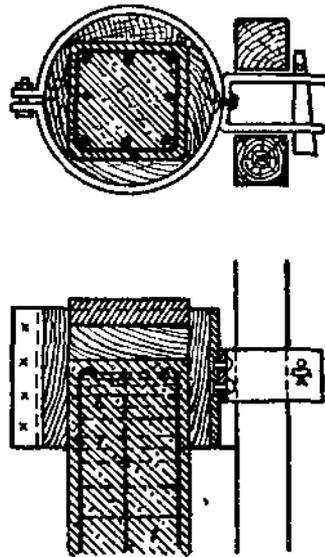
представляет собою железобетонную сваю Консидера, повторяющую его метод армирования, применяемый к стойкам, носящий наименование „обоймы“.
